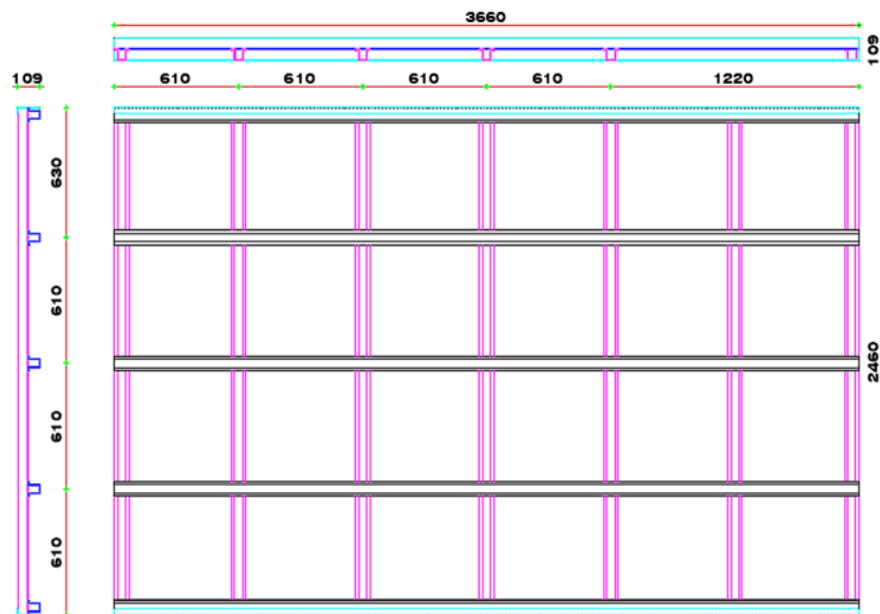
Dimensiones del Panel Llano de 3.660mm x 2.460mm
